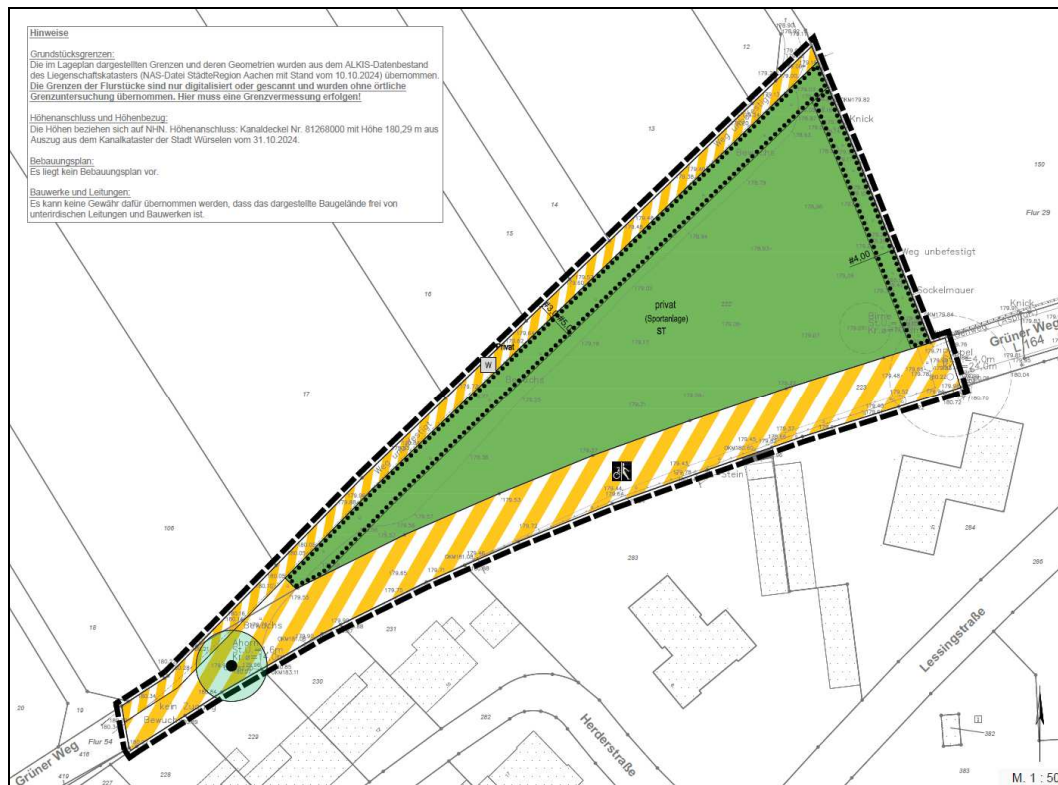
Entwurf des Bebauungsplans [13]
